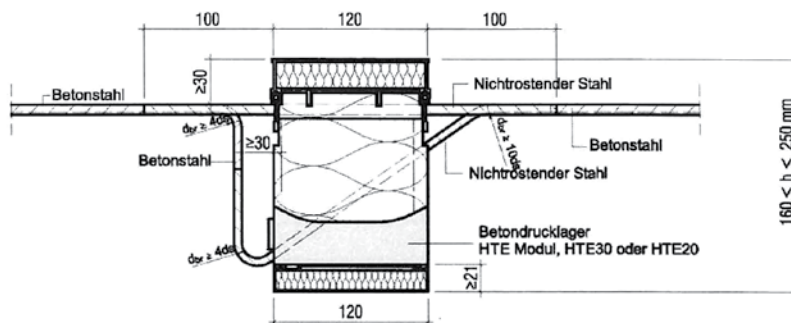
Schöck Isokorb Typ K¹⁾ mit integrierter Aufhängebewehrung gem. Abschn. 3.3.1
